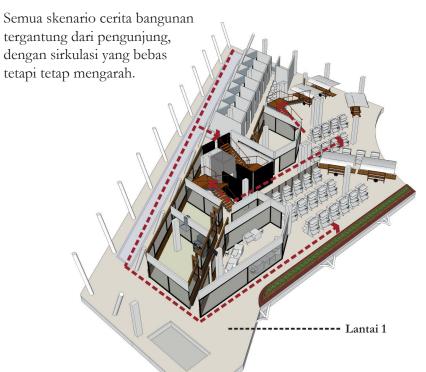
Konsep Per-ruang Lantai Ground Floor
